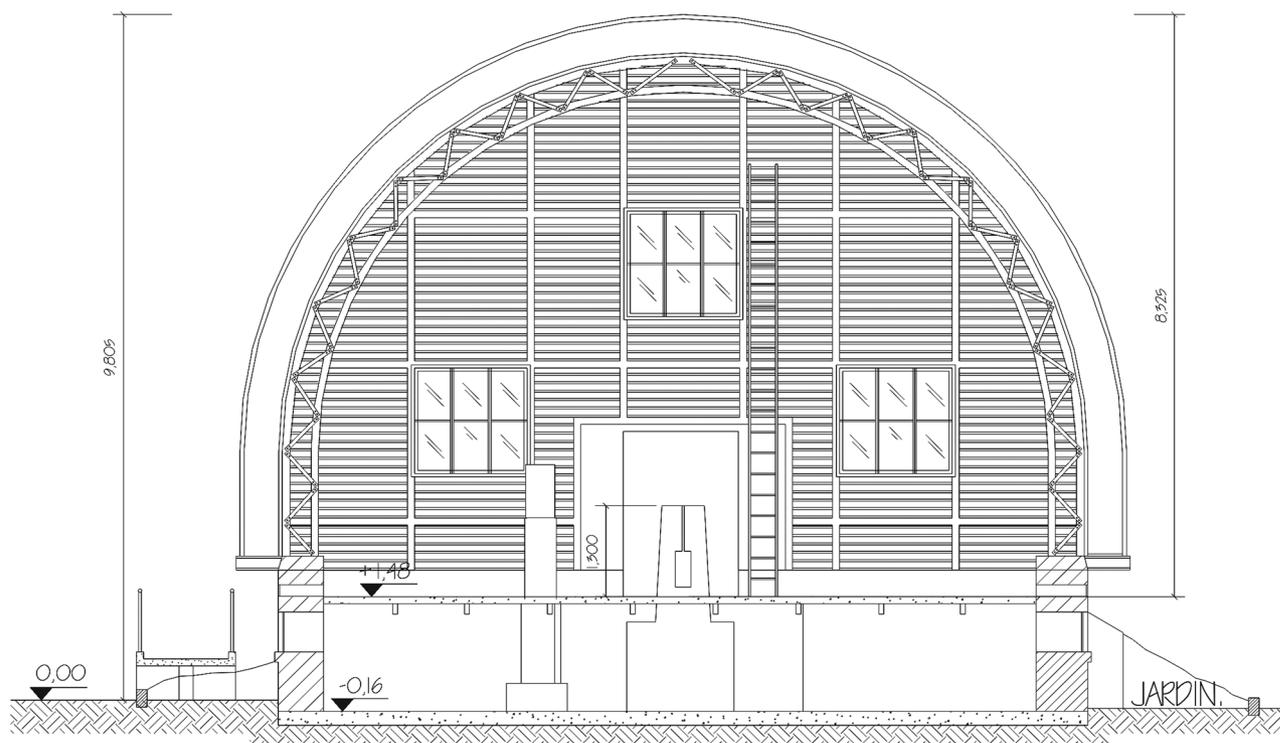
Corte AB. Desenho de reabilitação do pavilhão da luneta meridiana de Gautier. Arquivo MAST, Rio de Janeiro.
